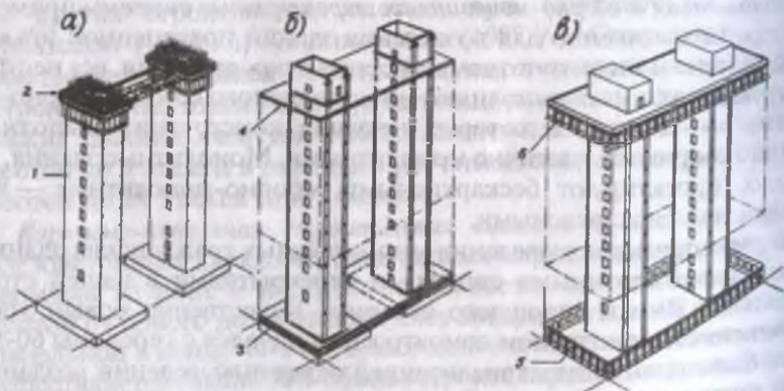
Схема конструкций сборно-монолитных зданий: а — монолитные стволы жесткости; б — схема конструкций, возводимых методом подъема перекрытий; в — то же, методом подъема этажей; 1 — ствол жесткости; 2 — скользящая опалубка; 3 — пакет монолитных перекрытий размером на здание; 4 — перекрытие в проектное положение; 5 — этаж перед подъемом; б — этаж в проектное положение
